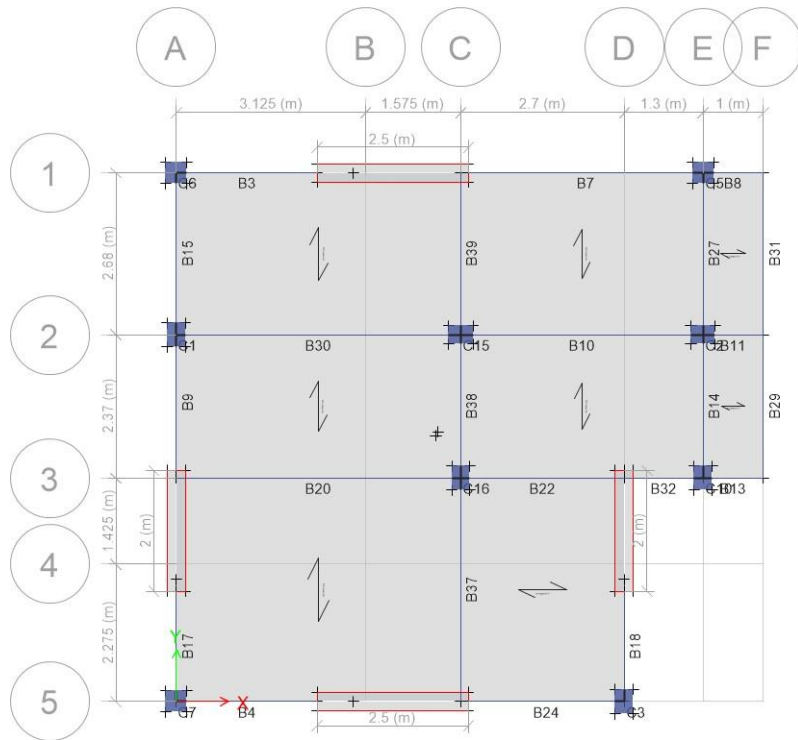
Elementos estructurales colocados correctamente en ETABS. Fuente propia.
